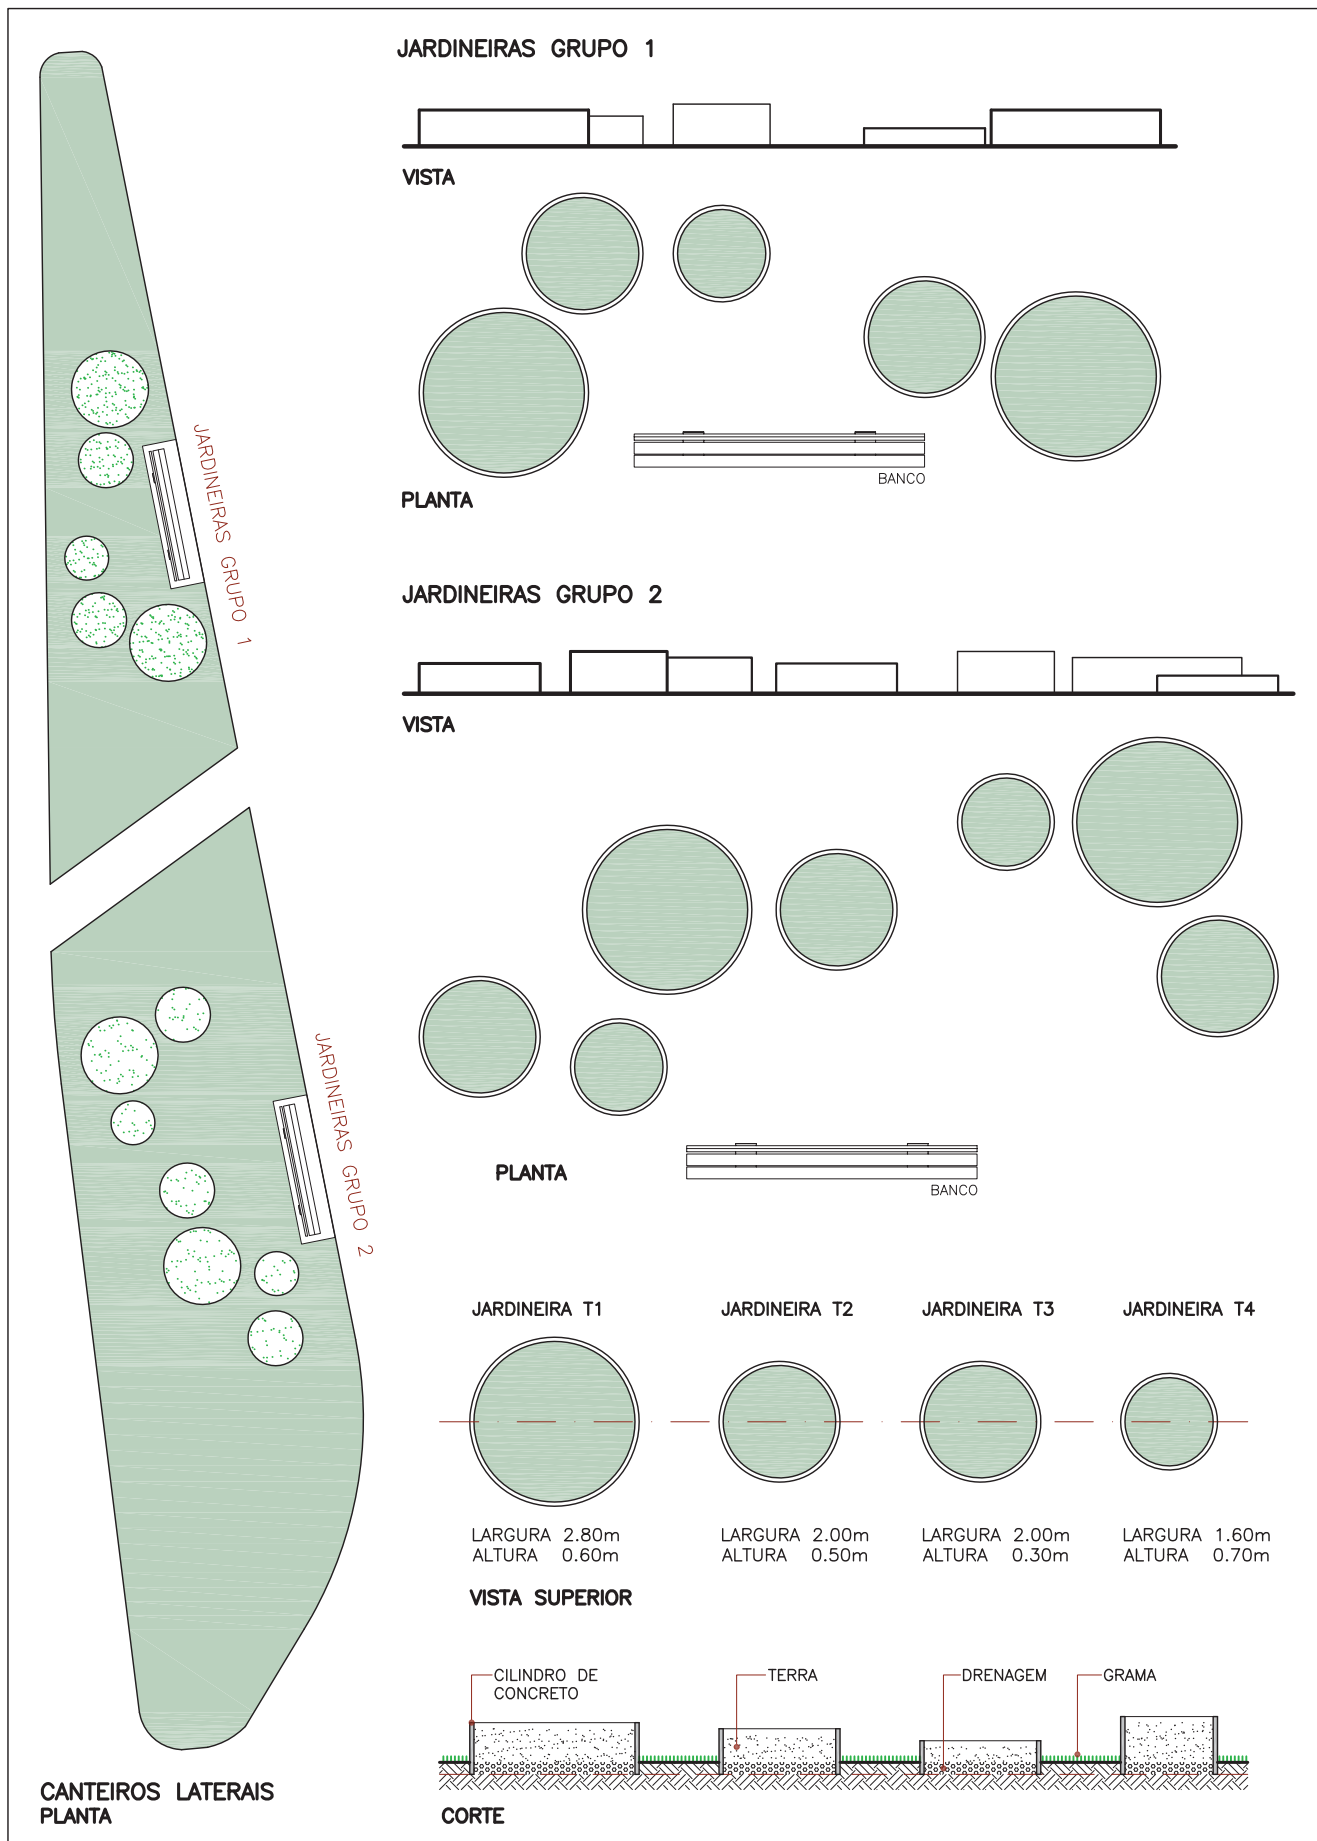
Praça de Pedestres Norte-Sul - Canteiros
